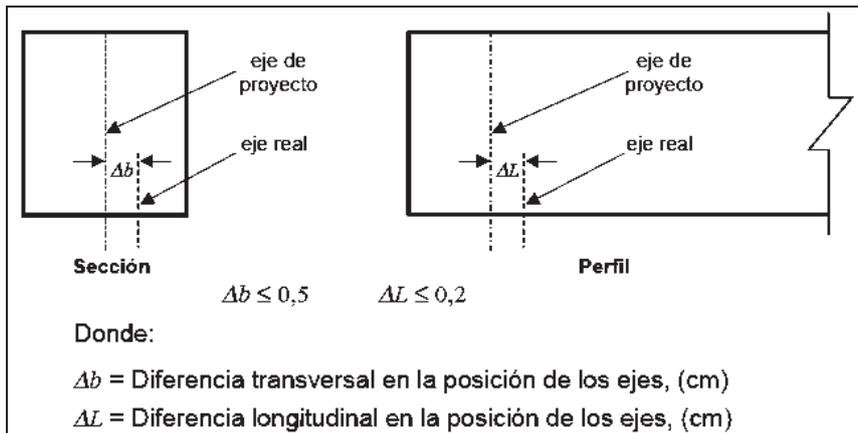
Tolerancia para posición de trabes [16].
